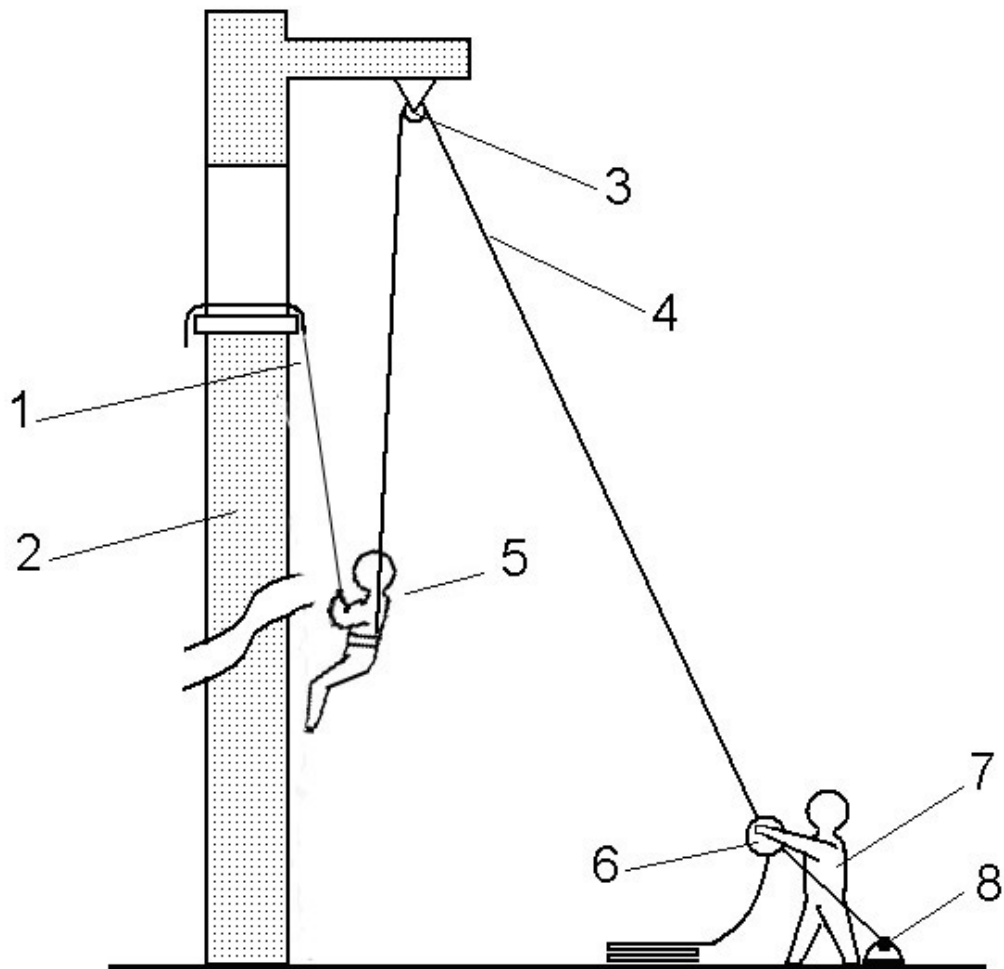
Схема обеспечения верхней страховки с точкой крепления
